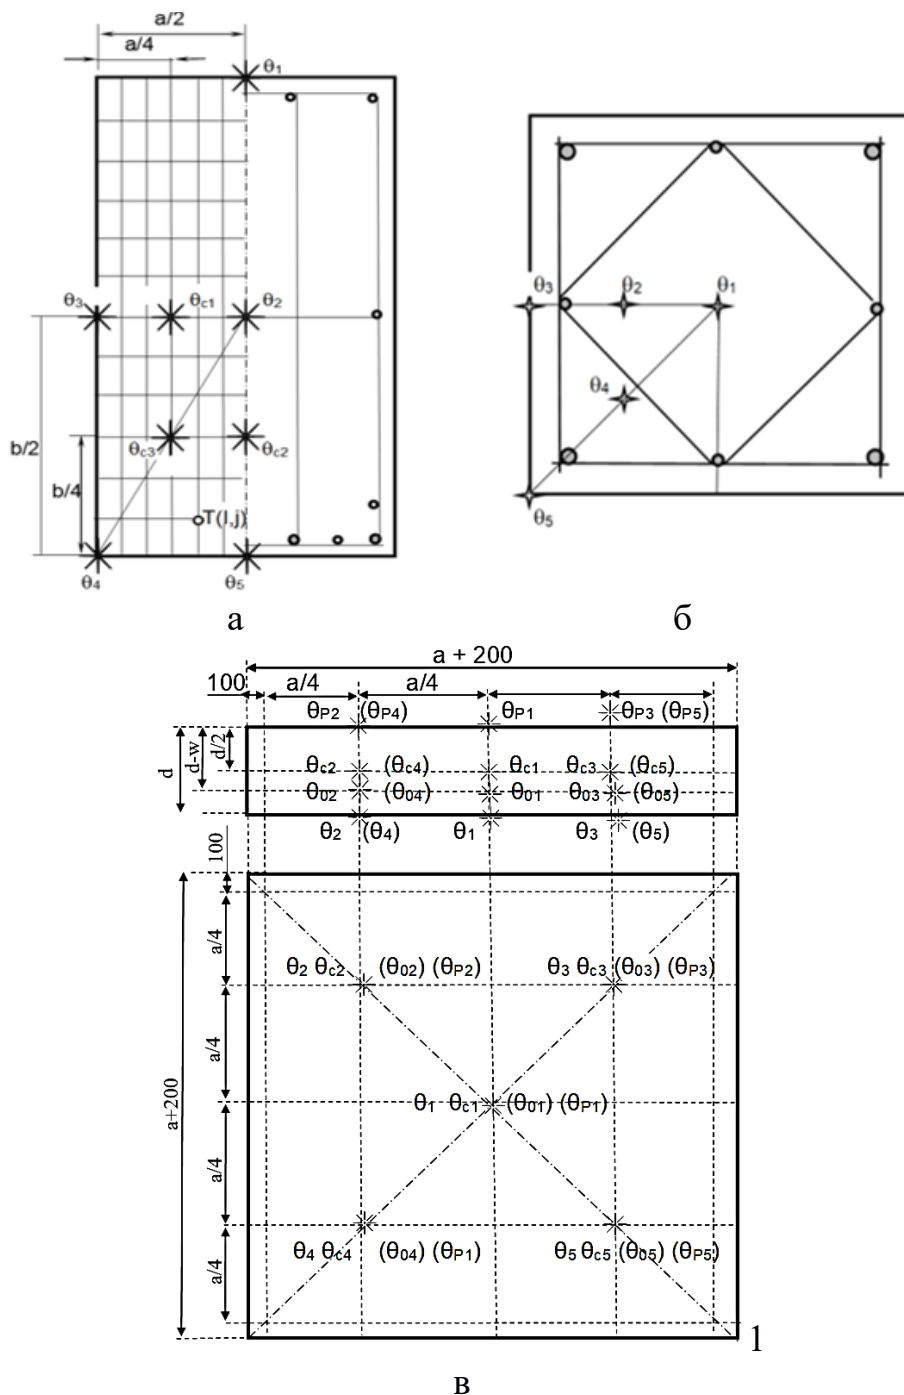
Схеми розташування термопар та розбиття фрагментів елементів несучих залізобетонних конструкцій на перерізи: а – балки, б – колони, в – плити та стіни.
